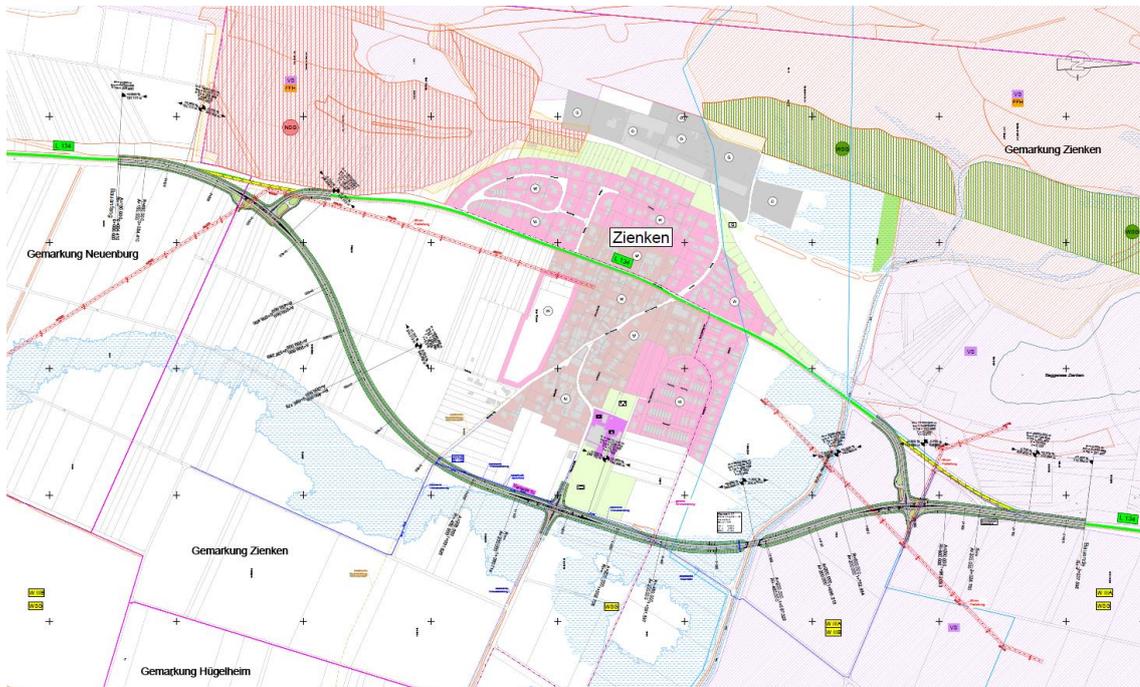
Lageplan Variante 1c (vgl. Unterlage Nr. U 5_3)
